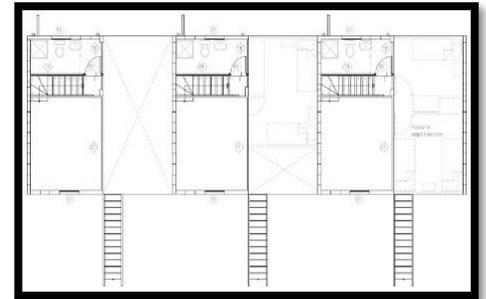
Plan du 2eme étage du projet.(source: archdaily.com).
